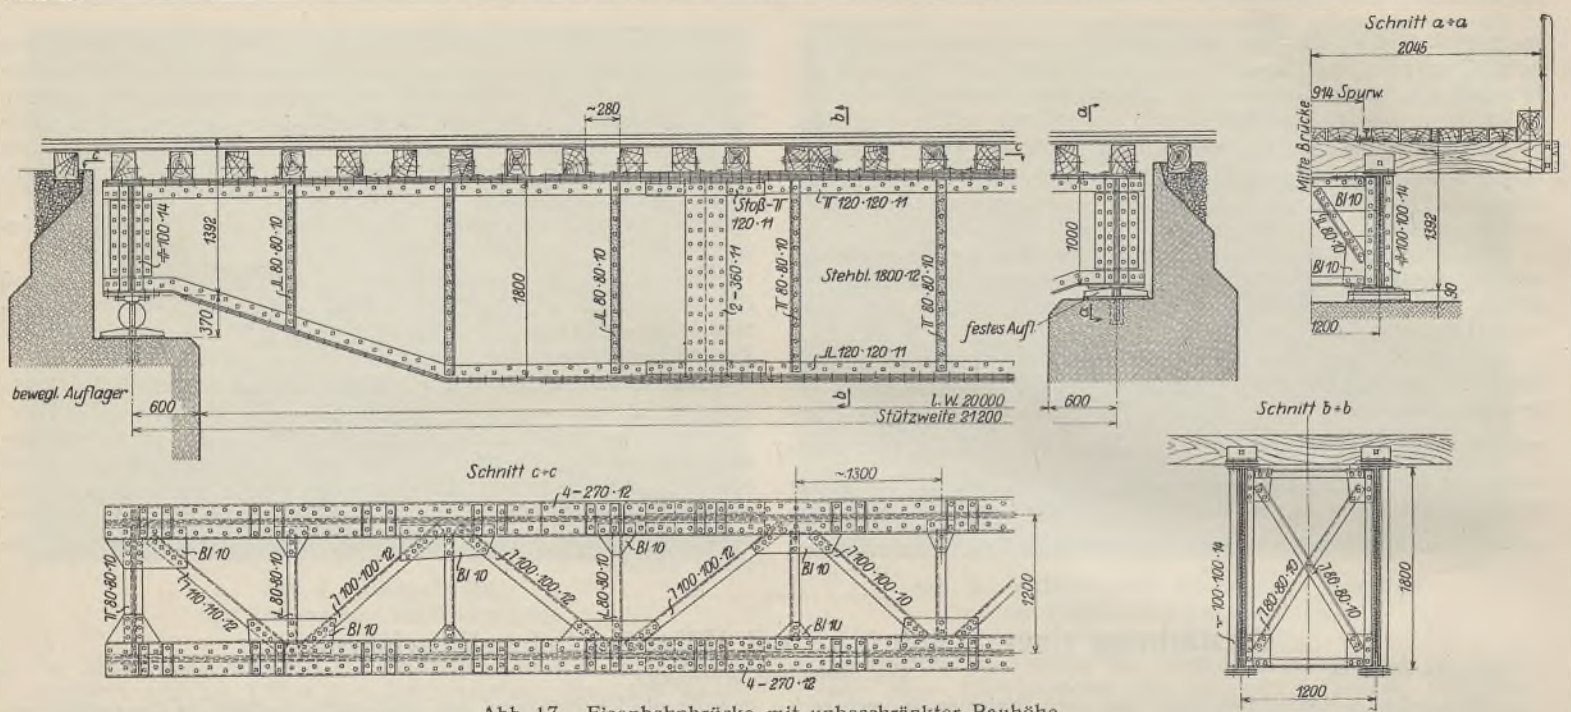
Eisenbahnbrücke mit unbeschränkter Bauhöhe.
